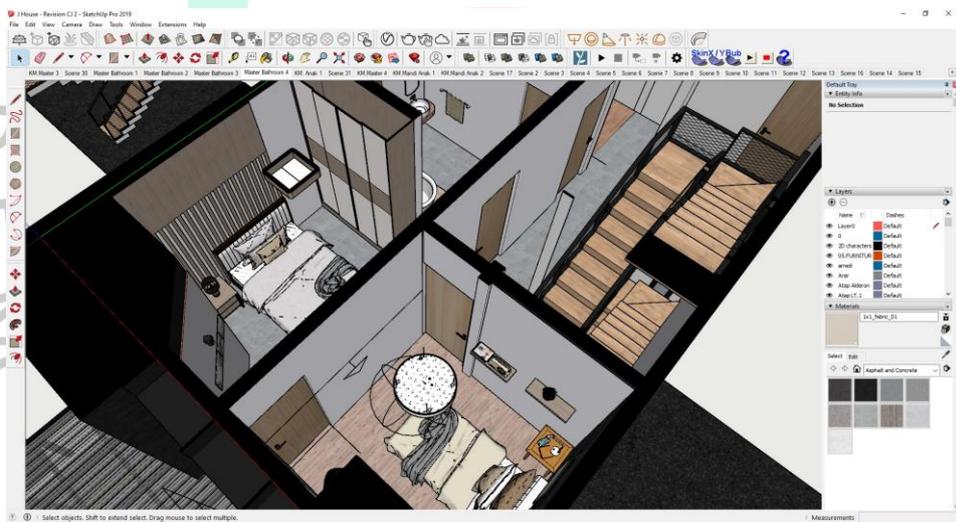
8 Denah Ruang Lantai Dua J House, Sumber : Arsip Kantor
